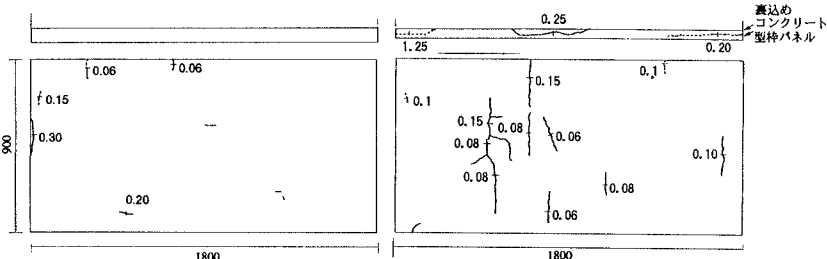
暴露供試体ひび割れ発生状況（数値はひび割れ幅）
